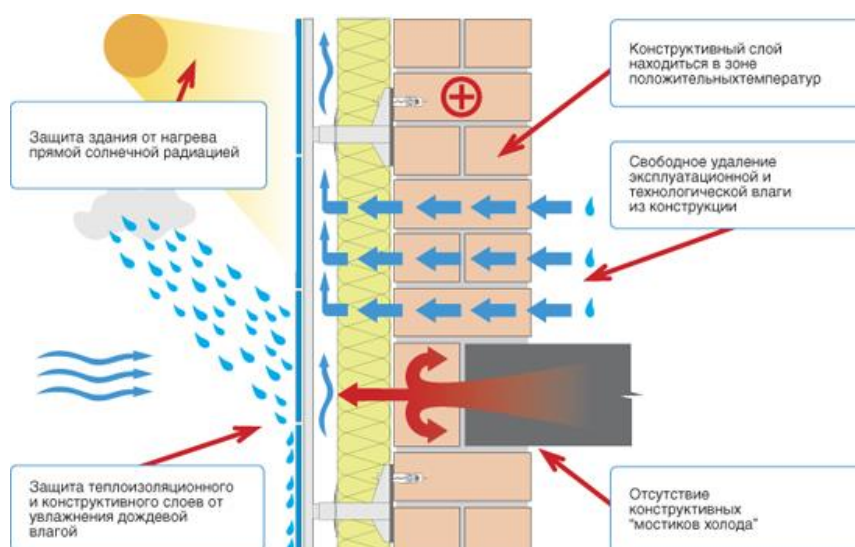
Схема - Принцип работы вентилируемого фасада
